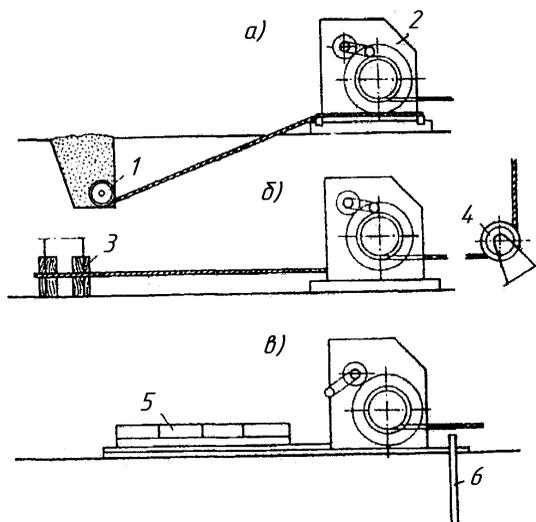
Схема закрепления лебедок: а – за якорь; б - за конструкцию здания; в - загрузкой балласта; 1 – стационарный якорь; 2 – лебедка; 3 – колонна; 4 – отводной блок; 5 – балласт; 6 – свайный якорь
